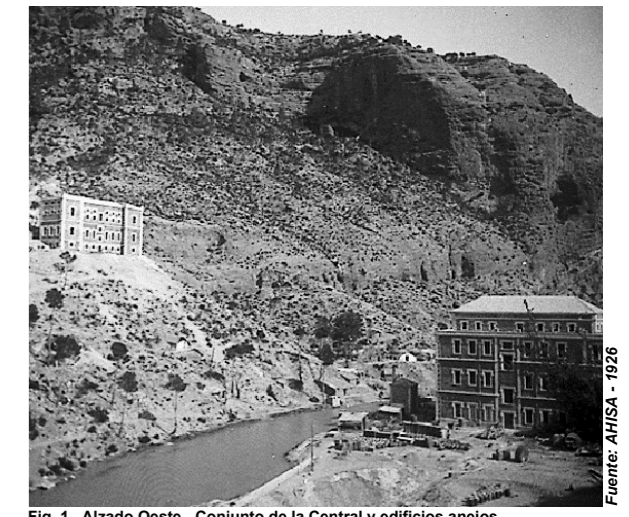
Alzado Oeste - Conjunto de la Central y edificios anejos.
